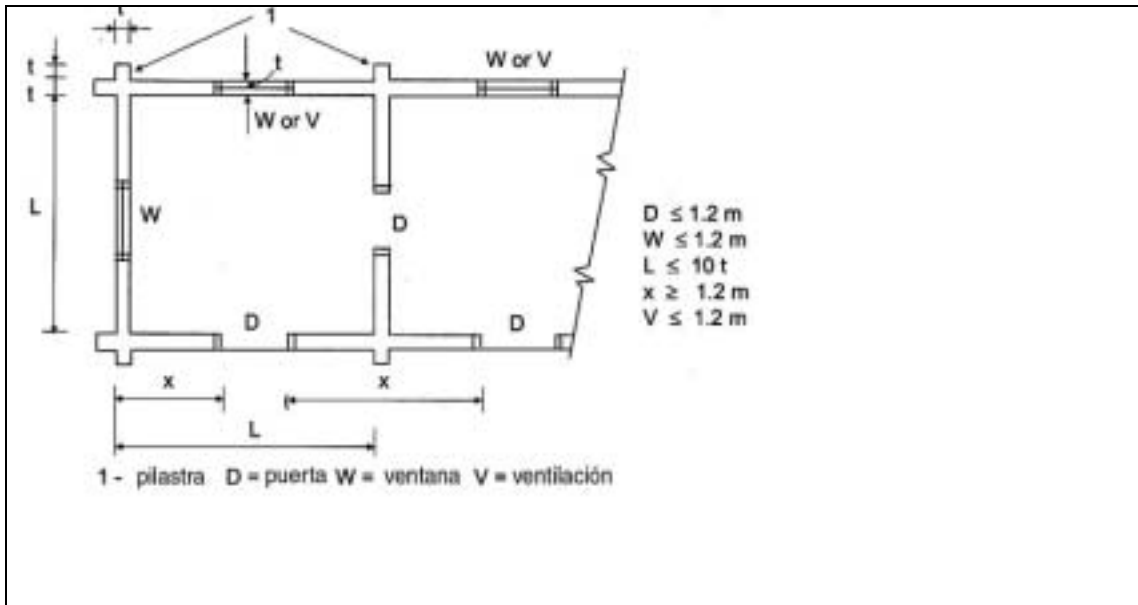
Guía para la Construcción de Muros con Contrafuertes y Pilastras (IAEE 1986)
